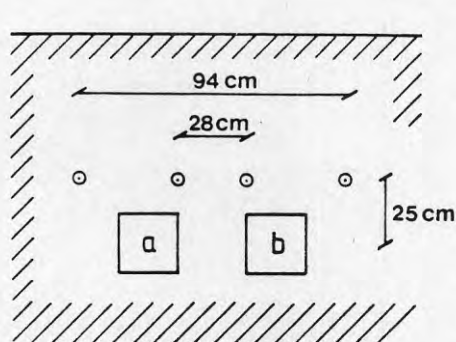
Fjärrvärmekulvert med fyra kringliggande värmeåtervinningslangar.
